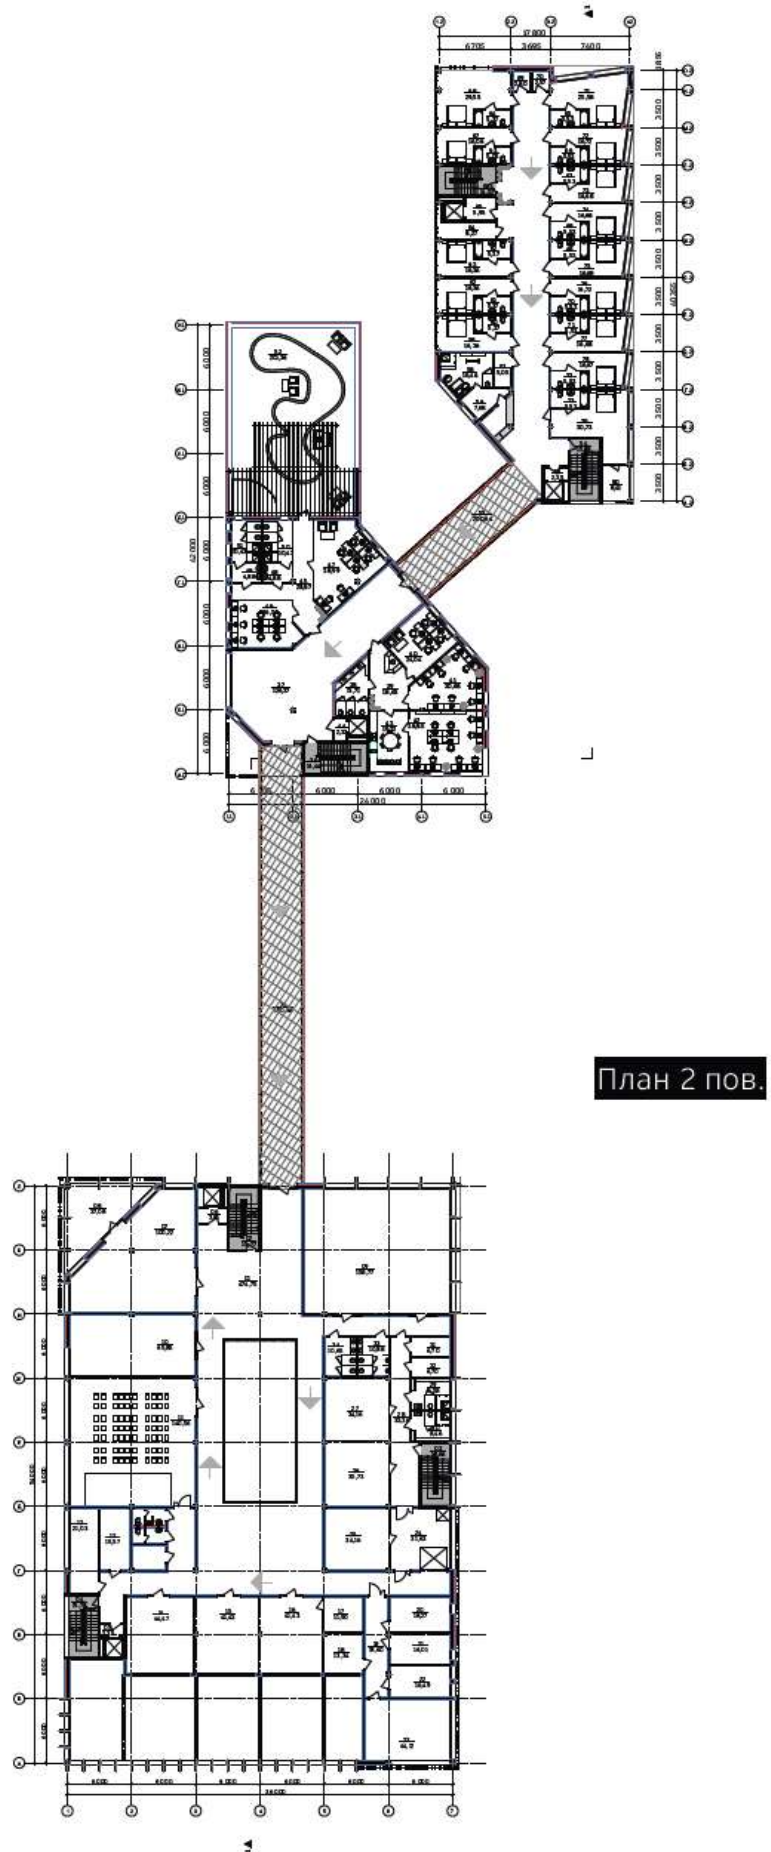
План 2-го поверху на відм. +4,600з експлікацією
